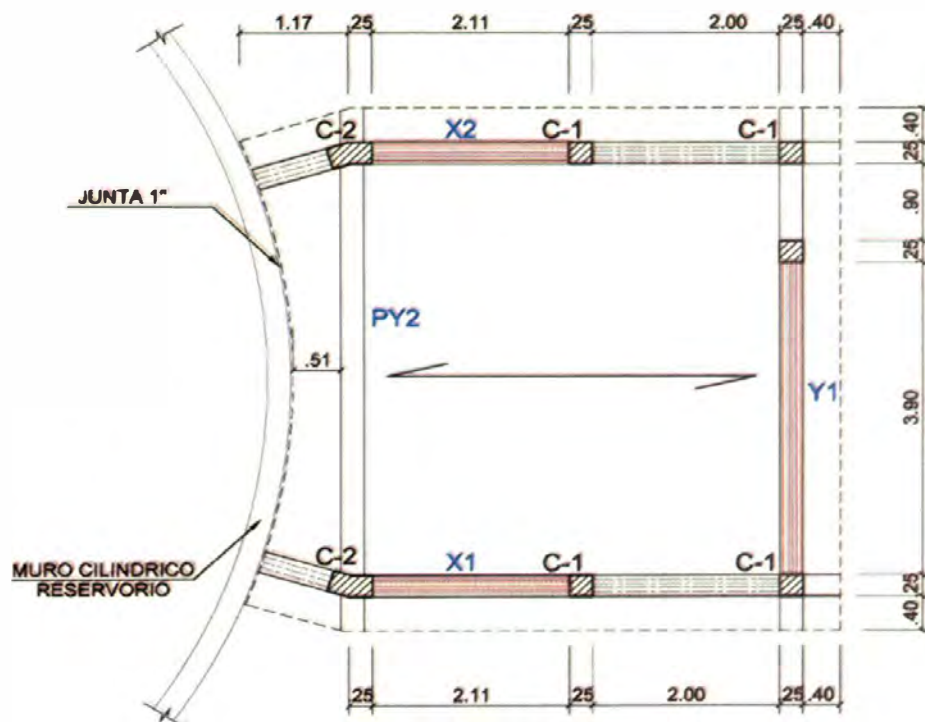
Planta de estructuración propuesta para la caseta de válvulas.
